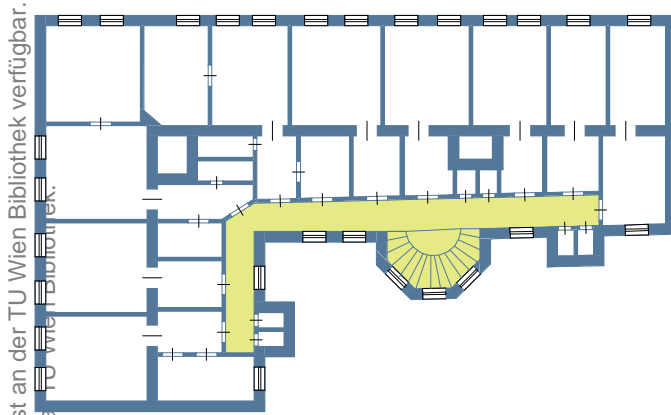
Grundriss eines Gründerzeithauses mit Erschließung über ein Stiegenpodest
